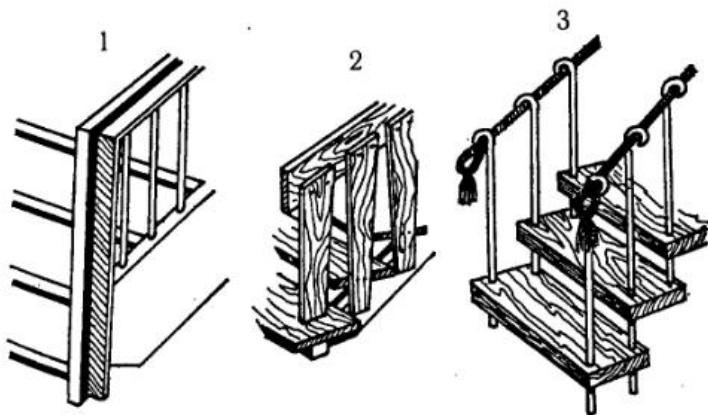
Конструкции перил: 1, 2 — деревянные; 3 — деревянные с металлическими стойками.
